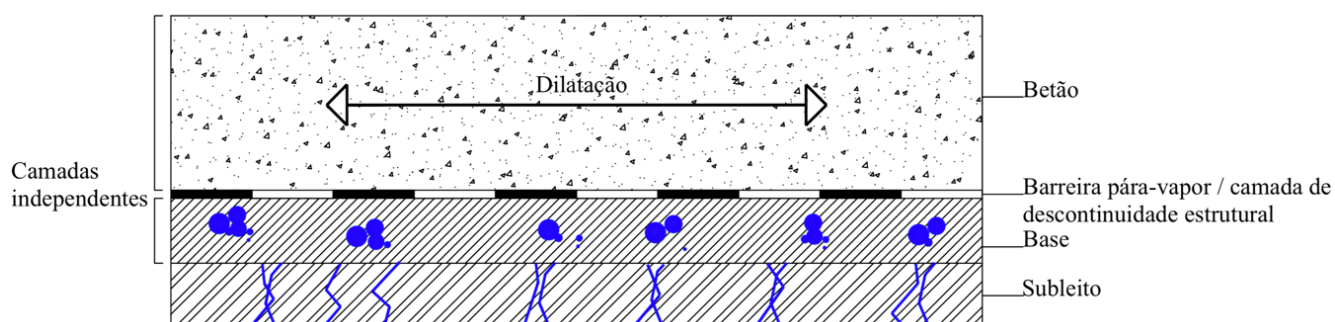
Pormenor construtivo [adaptado 34]
